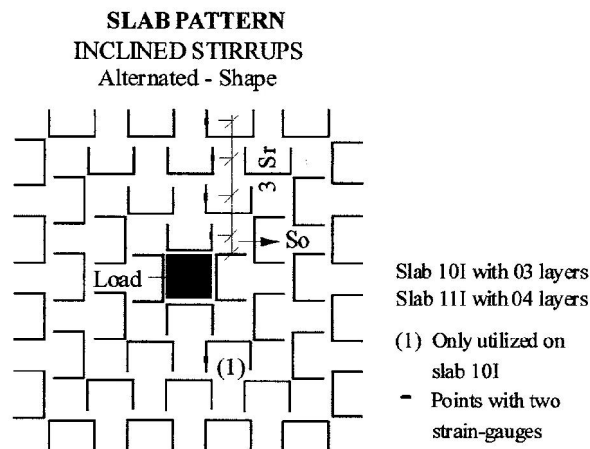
Armaduras de punçoamento inclinadas: distribuição alternativa [53].
